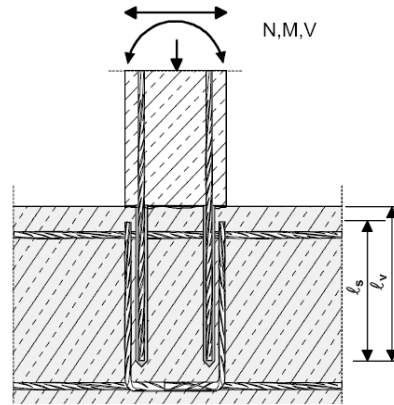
Recouvrement d'armatures pour la liaison d'un poteau ou d'un mur sur une fondation avec armatures en traction
